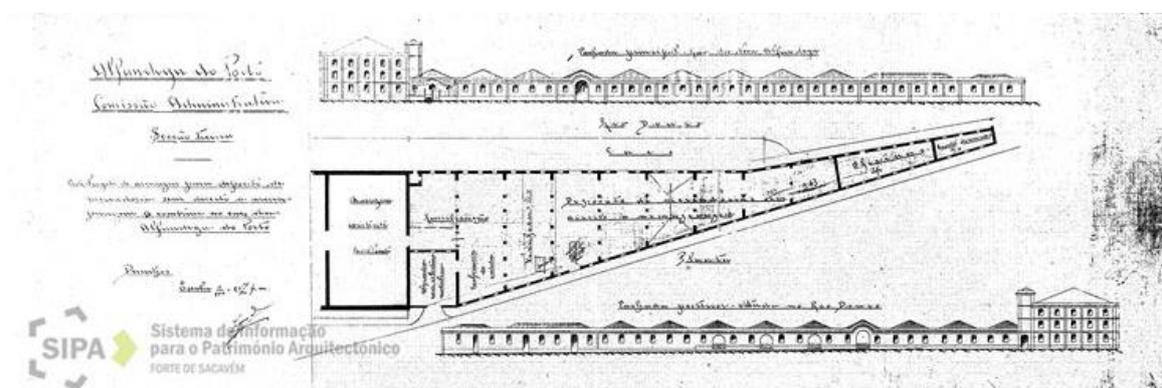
Planta; Fachada principal, Rua da Nova Alfândega; Fachada posterior, voltada ao Rio Douro da Alfândega
